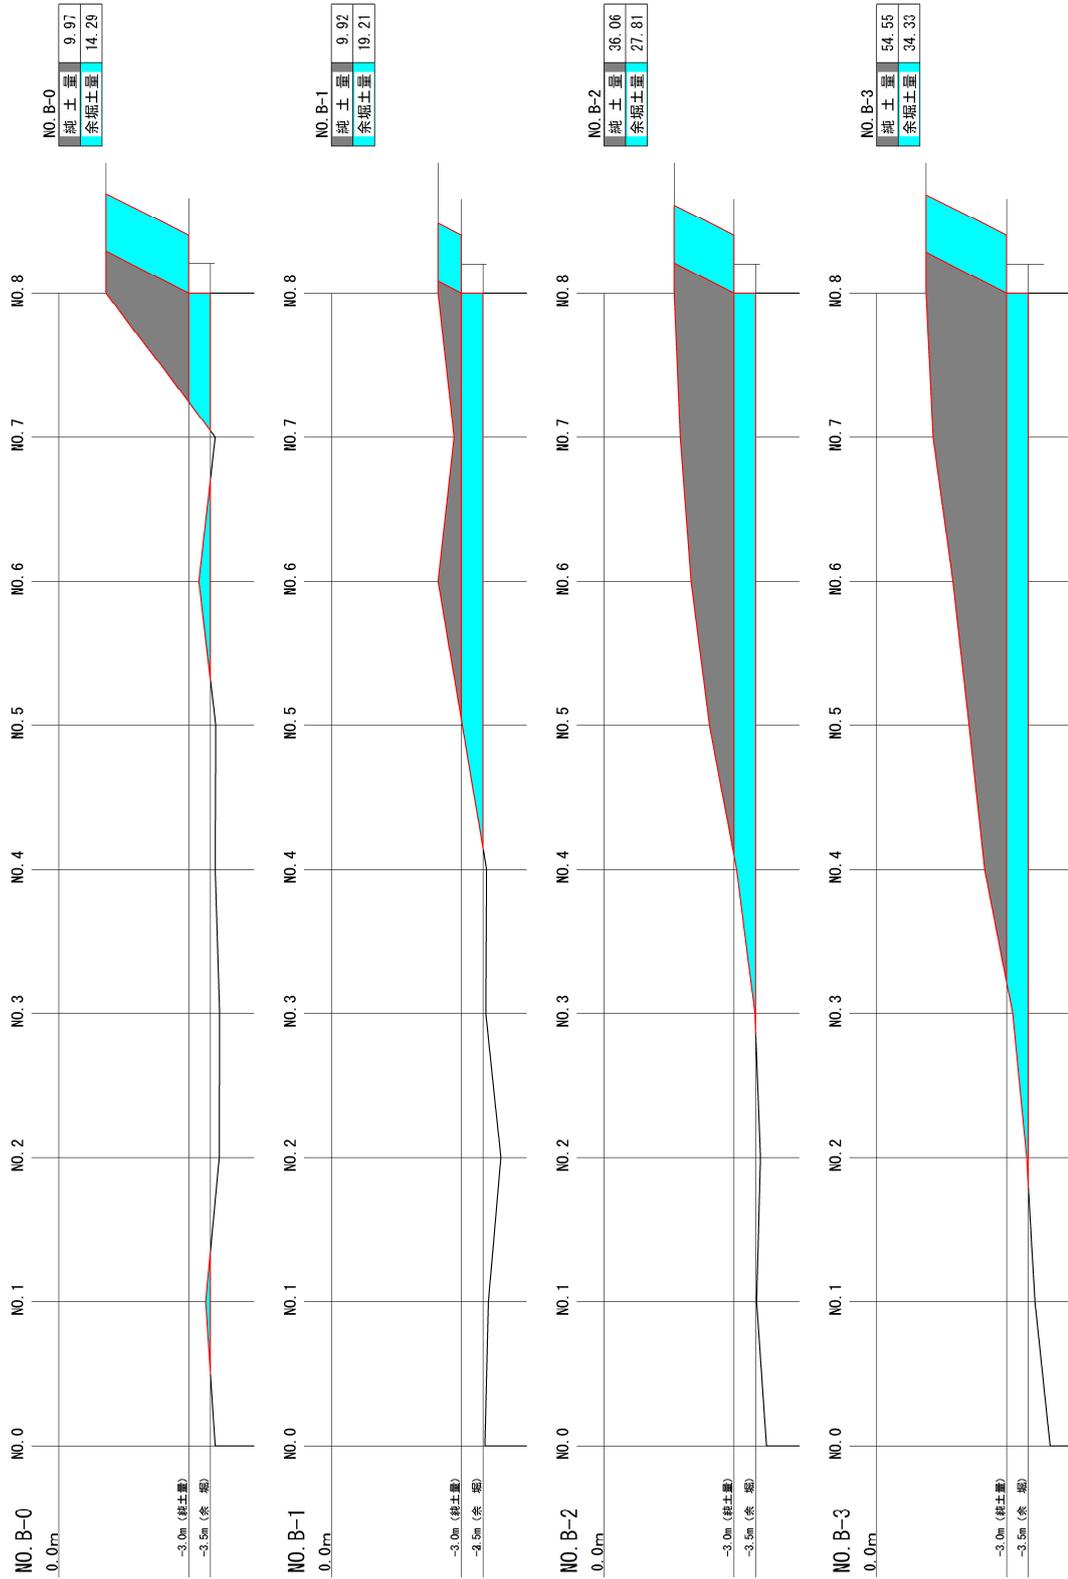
(1) 横断面 (B区) (測線 No. B-0~B-3)
